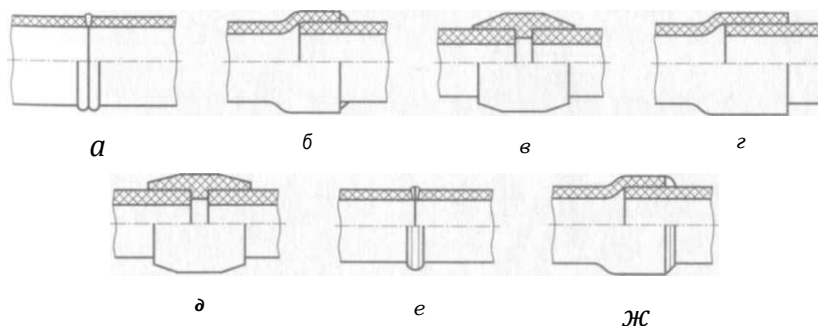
Неразъемные соединения трубопроводов из термопластов:
